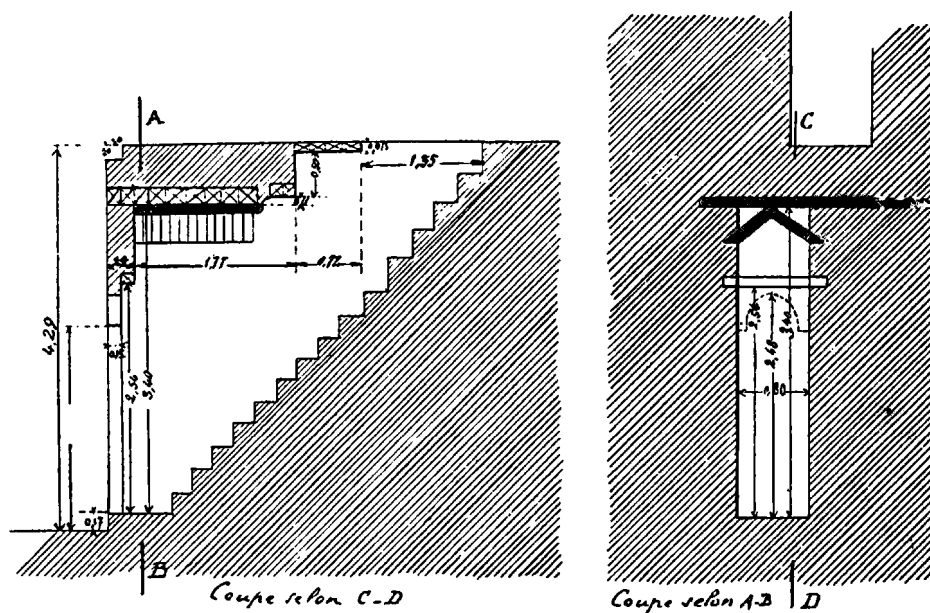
Escalier du rez-de-chaussée au premier étage
